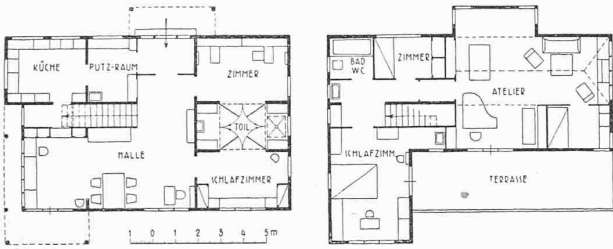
Grundrisse zum Hause Lux Guyer. — 1:300.
